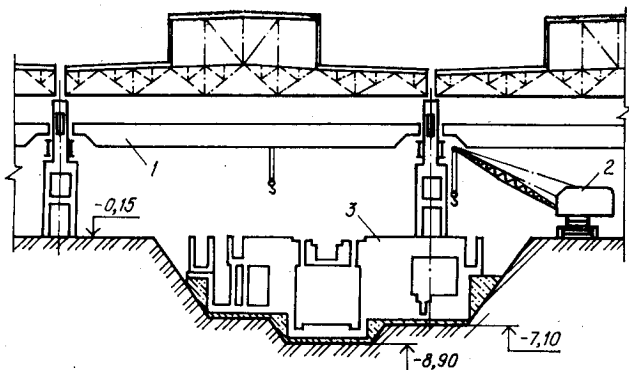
Бетонирование фундамента оборудования с использованием мостового и стрелового кранов:
